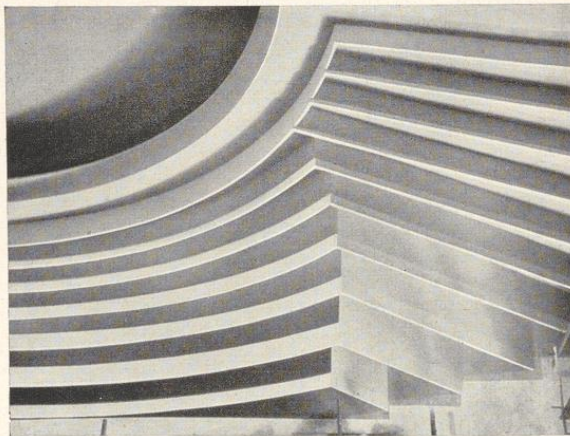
Rabitzschürzen in dem Metropol-Lichtspielhaus, Stuttgart. Ausführung Stuckgeschäft Hermann Enz, Stuttgart
